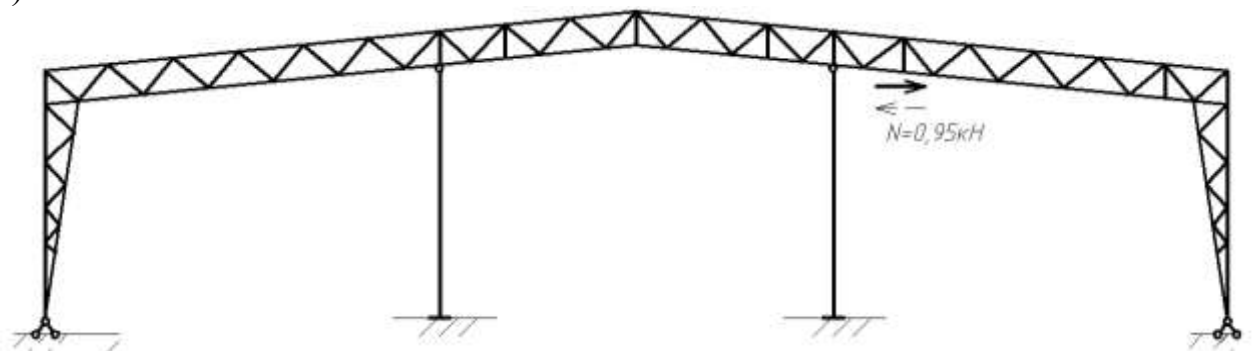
Схема загрузки крановой нагрузкой
